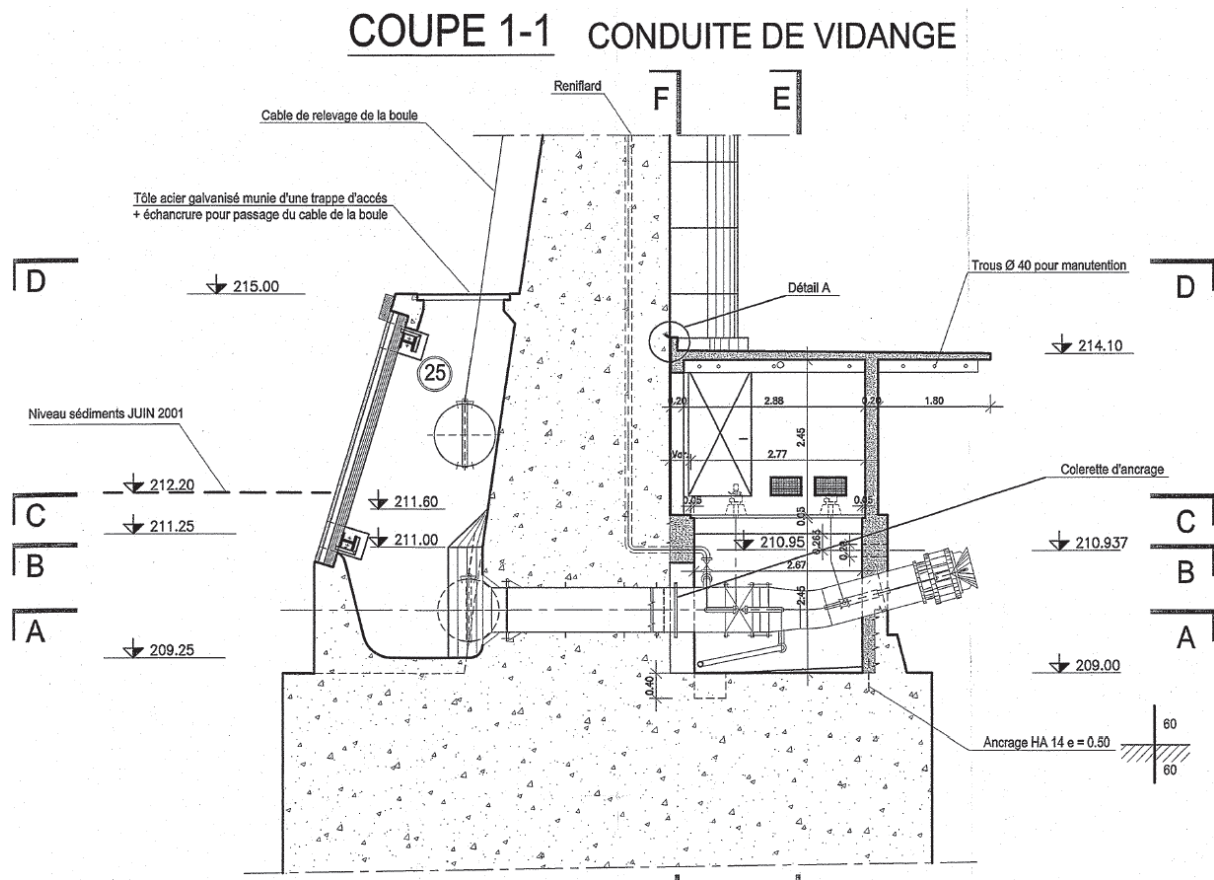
Coupe de l'ouvrage au droit du dispositif de vidange de fond
